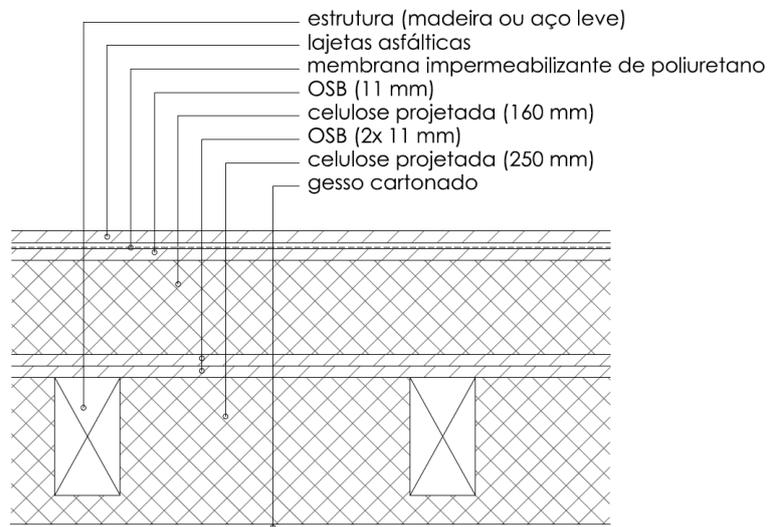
Laje de cobertura não-acessível (sem escala)
